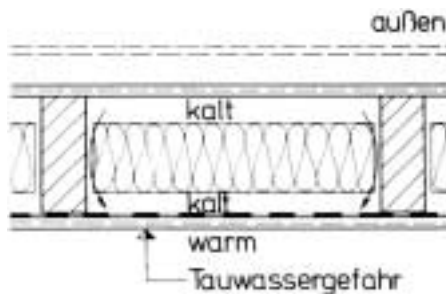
Konstruktionen vor 1985: Gefahr kalter Oberflächen trotz guter Wärmedämmung
